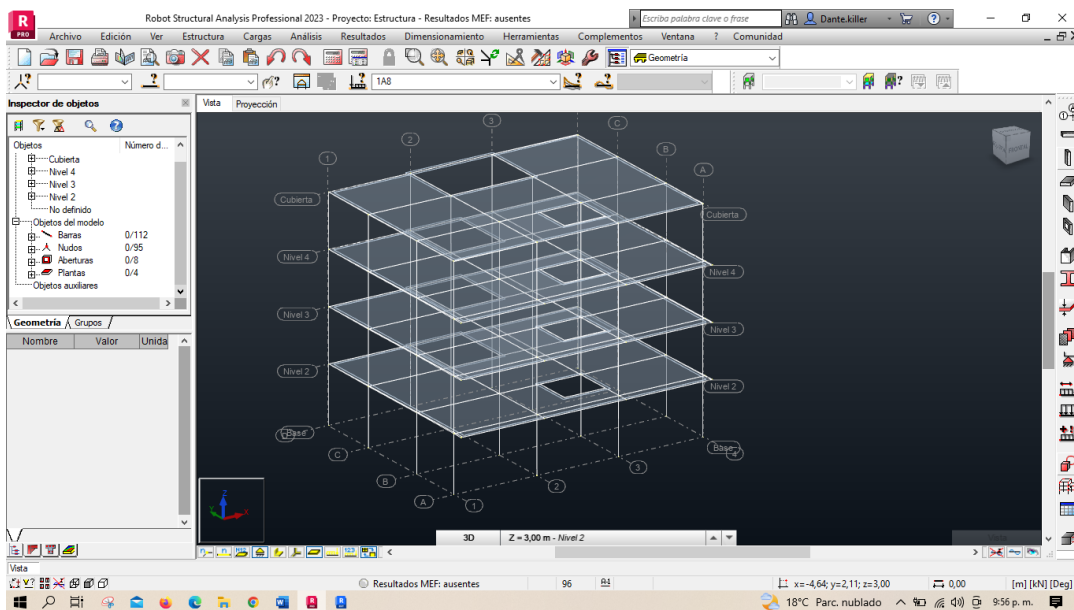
Vincular proyecto modelado en Revit con Robot Structural
